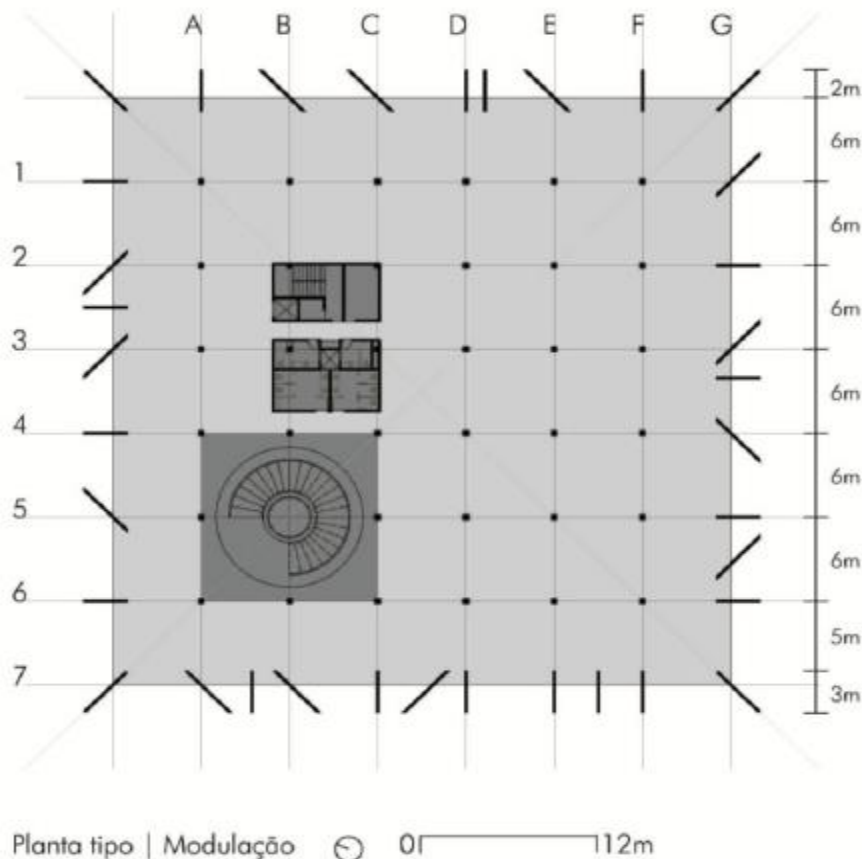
Planta Baixa pavimento tipo do edifício. Fonte: Ana Rosa Negreiros (2012).
